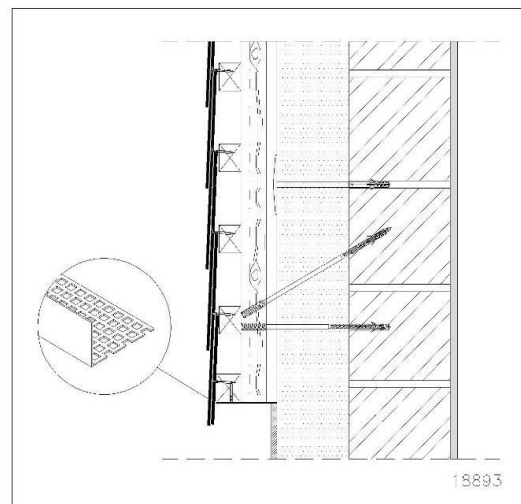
Onderrand - voorzetgevel – verticale doorsnede
